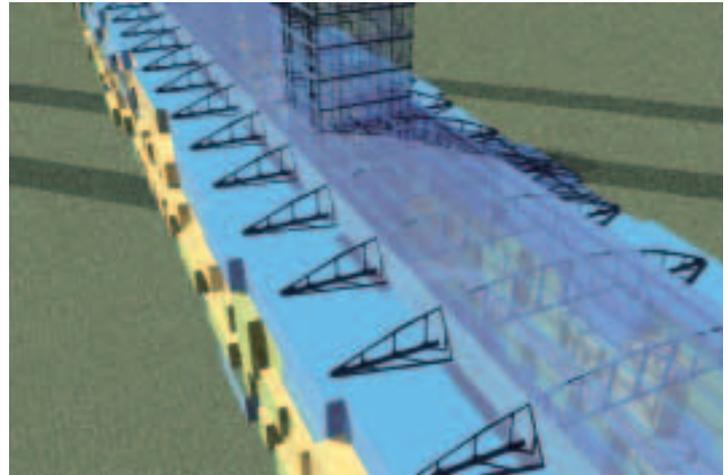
Detalle de cubierta de la subestructura S1 y su conexión con uno de los núcleos N1.
